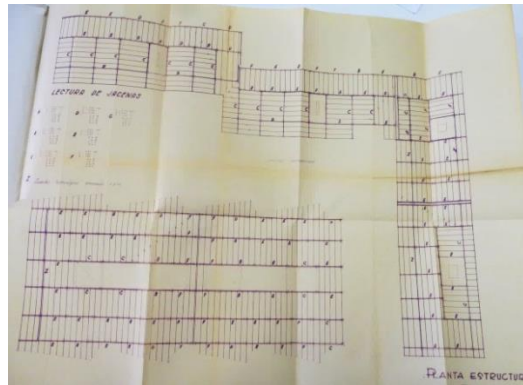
Plano original de la estructura de los apartamentos. Fuente AMAG.
